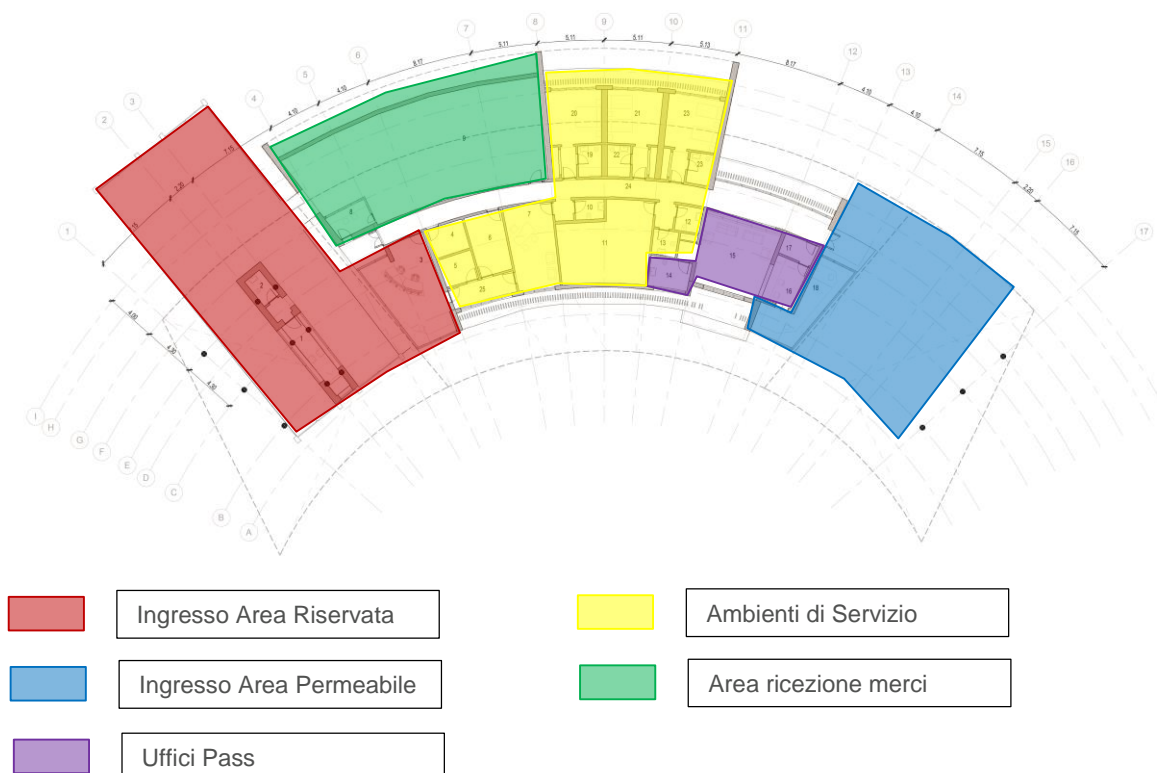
Planimetria schematica di progetto – Ingresso Principale - CO03
